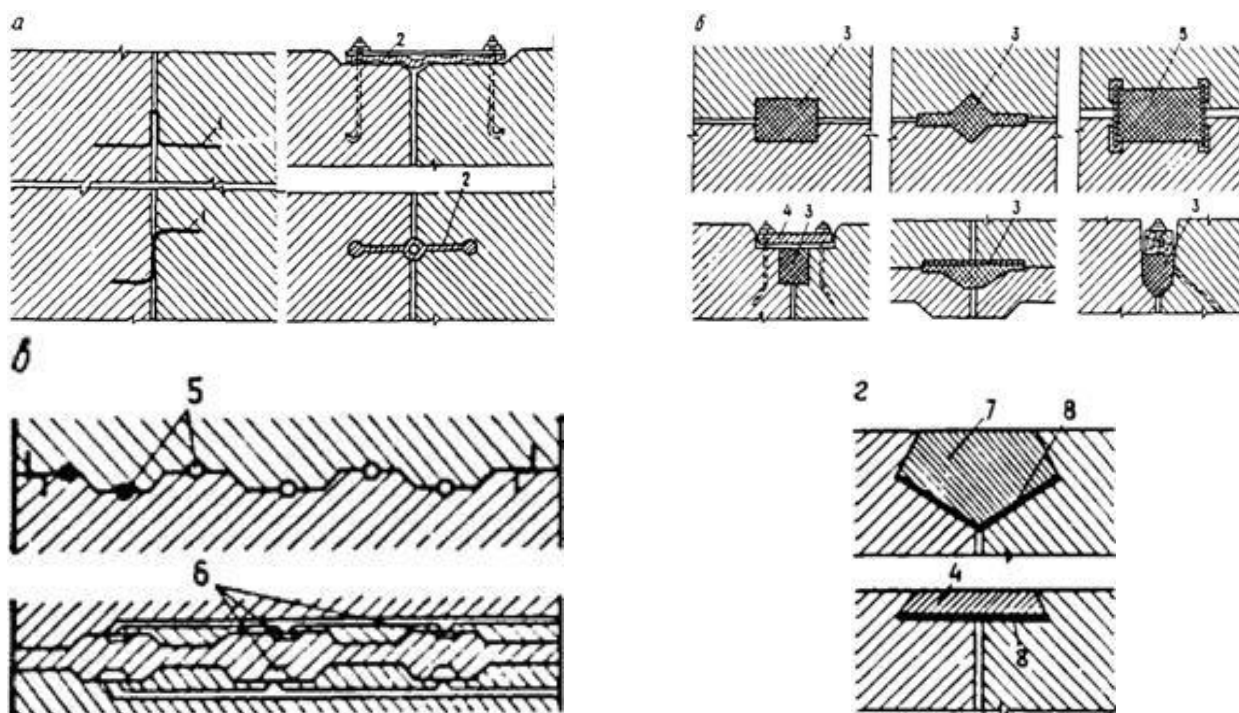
Схемы основных уплотнений деформационных швов бетонных и железобетонных плотин
